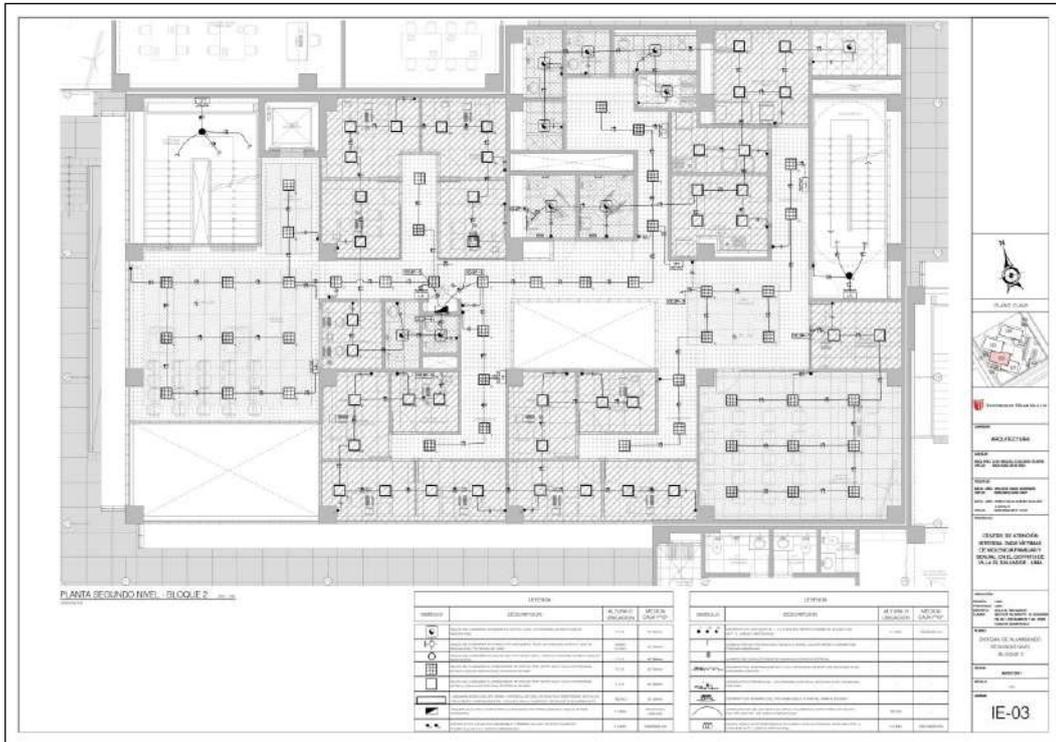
Planta segundo nivel sistema de alumbrado – bloque 2.
